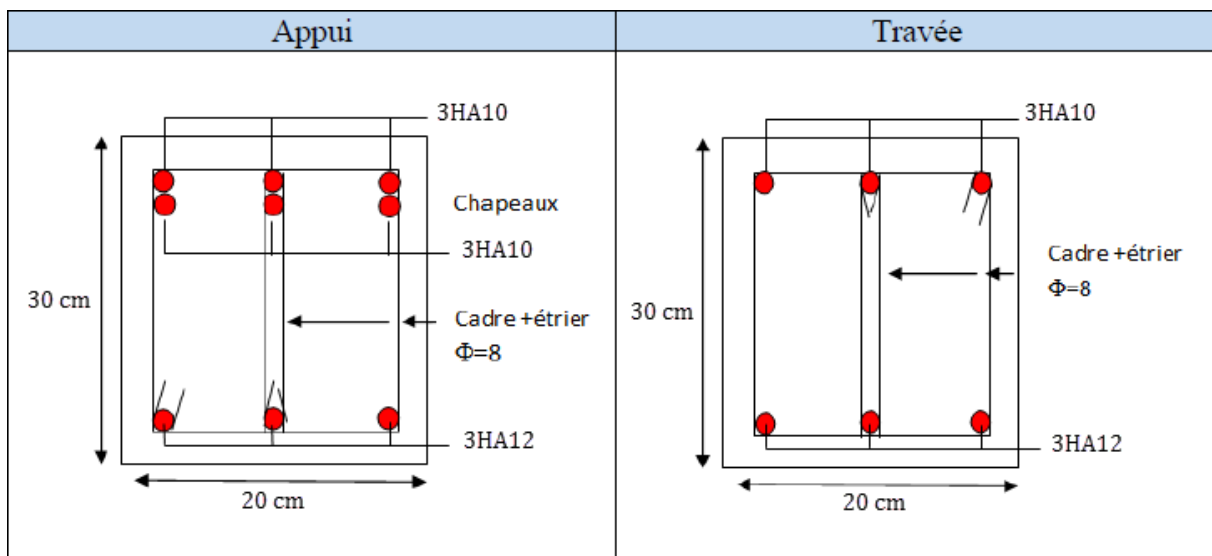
Schéma de ferrailage des poutres secondaires.
